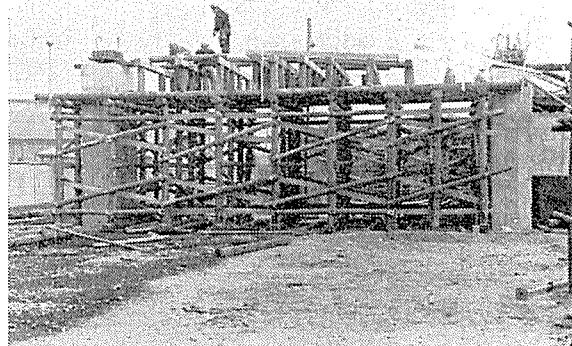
横ばり木製ステージングと主ばり方向のシース配置
